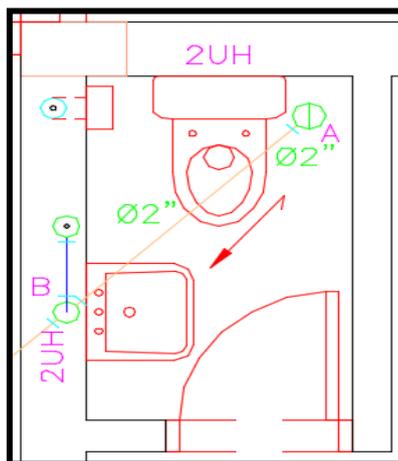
Distribución de descargas en Baño 1, Primer Nivel
